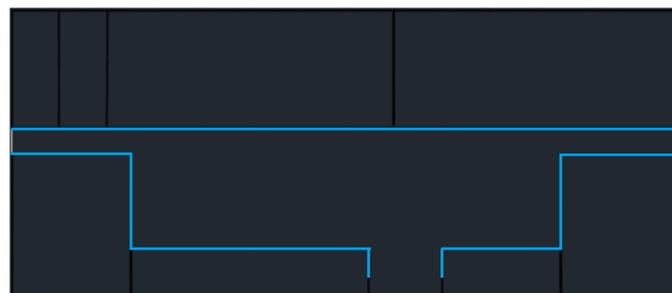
Perímetro interior (en azul) del edificio en planta baja (Elaboración propia)
